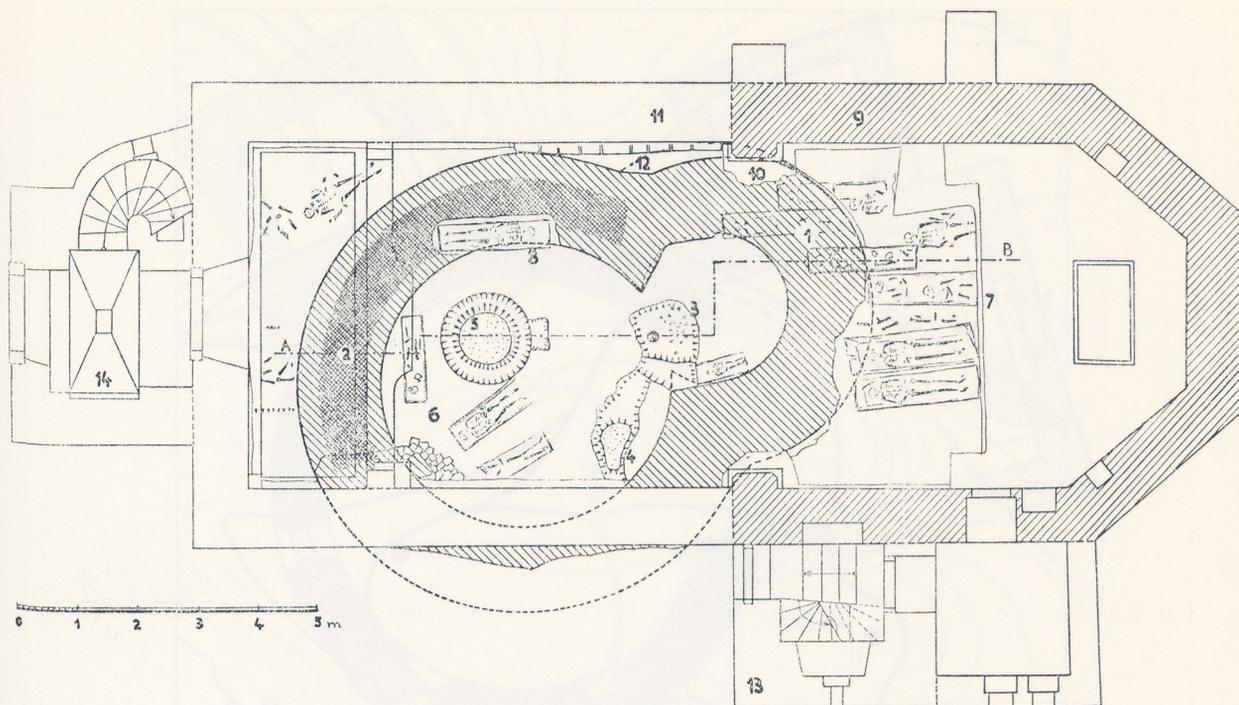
Grundriß der St. Klemens-Kirche auf dem Levý Hradec (nach Borkovský).
